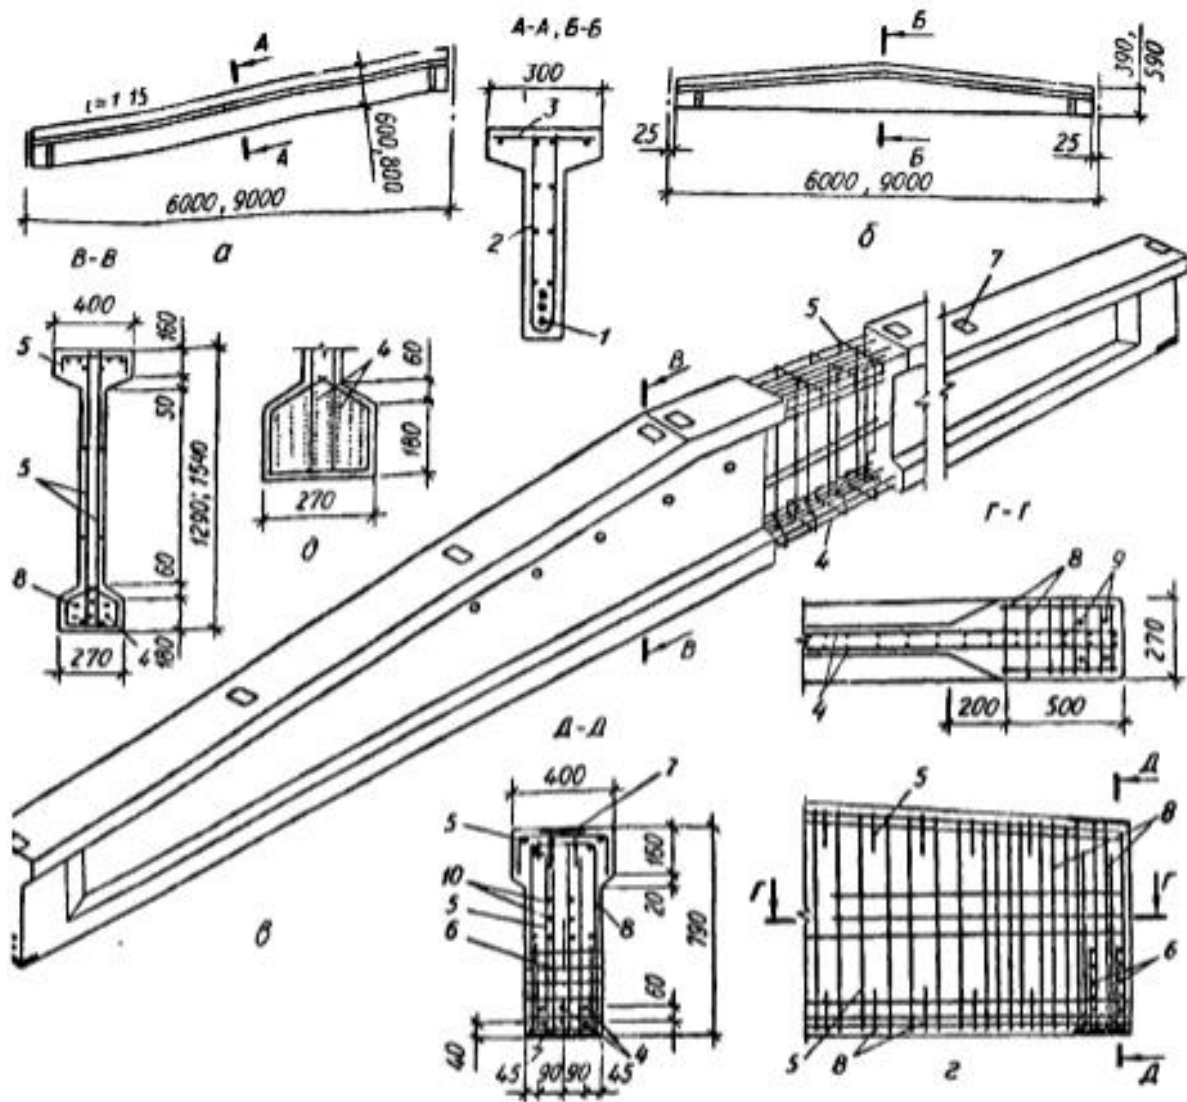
Балки покриття з ненапруженою і напруженою арматурою:
